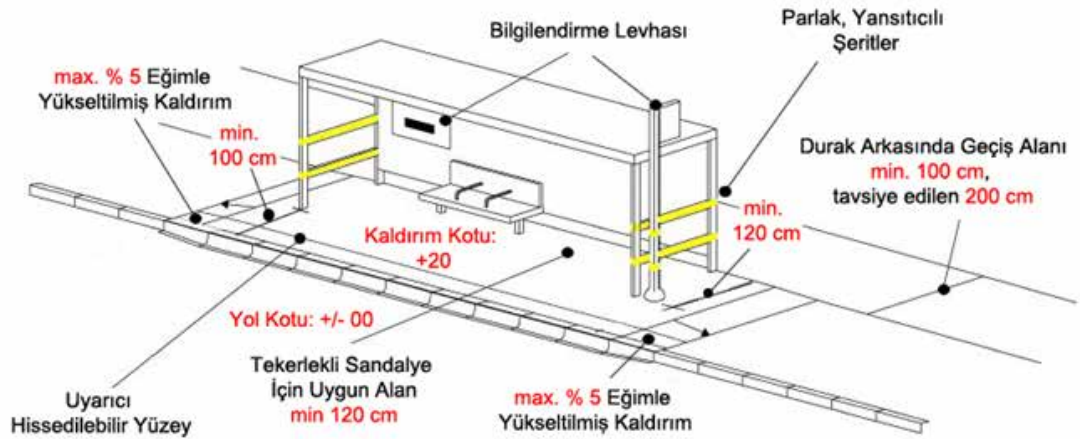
| Rakım Erkutlu Caddesi Otobüs Durağı
